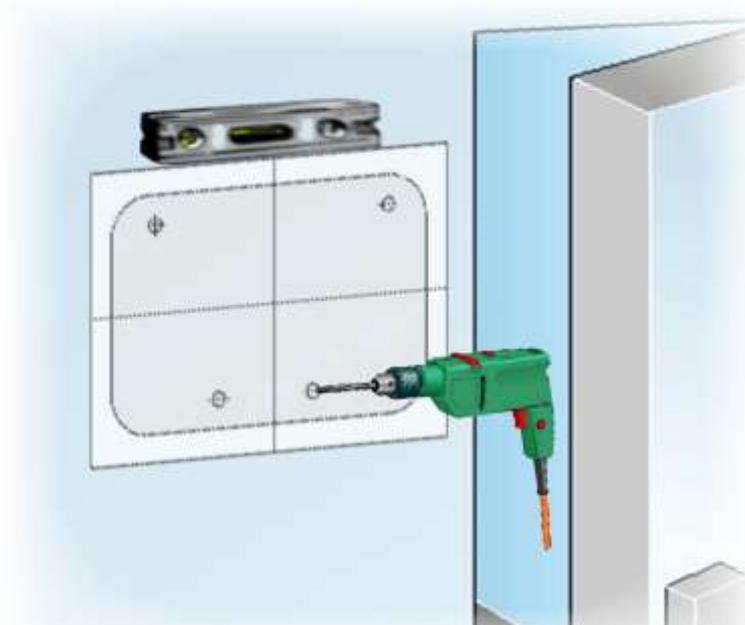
Utilizzando il foglio della dima di foratura fornito realizzare quattro fori di fissaggio sulla parete.
